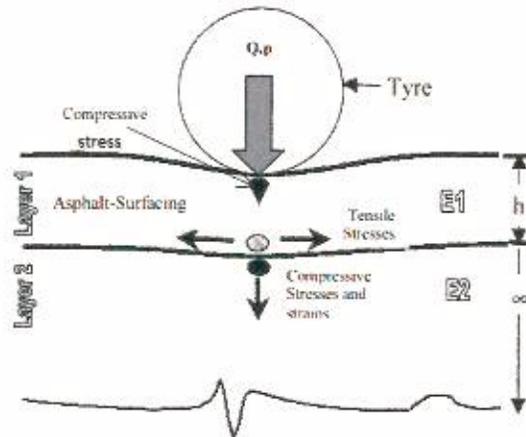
Estado de esfuerzos y deformaciones de una estructura de pavimento. [1]
